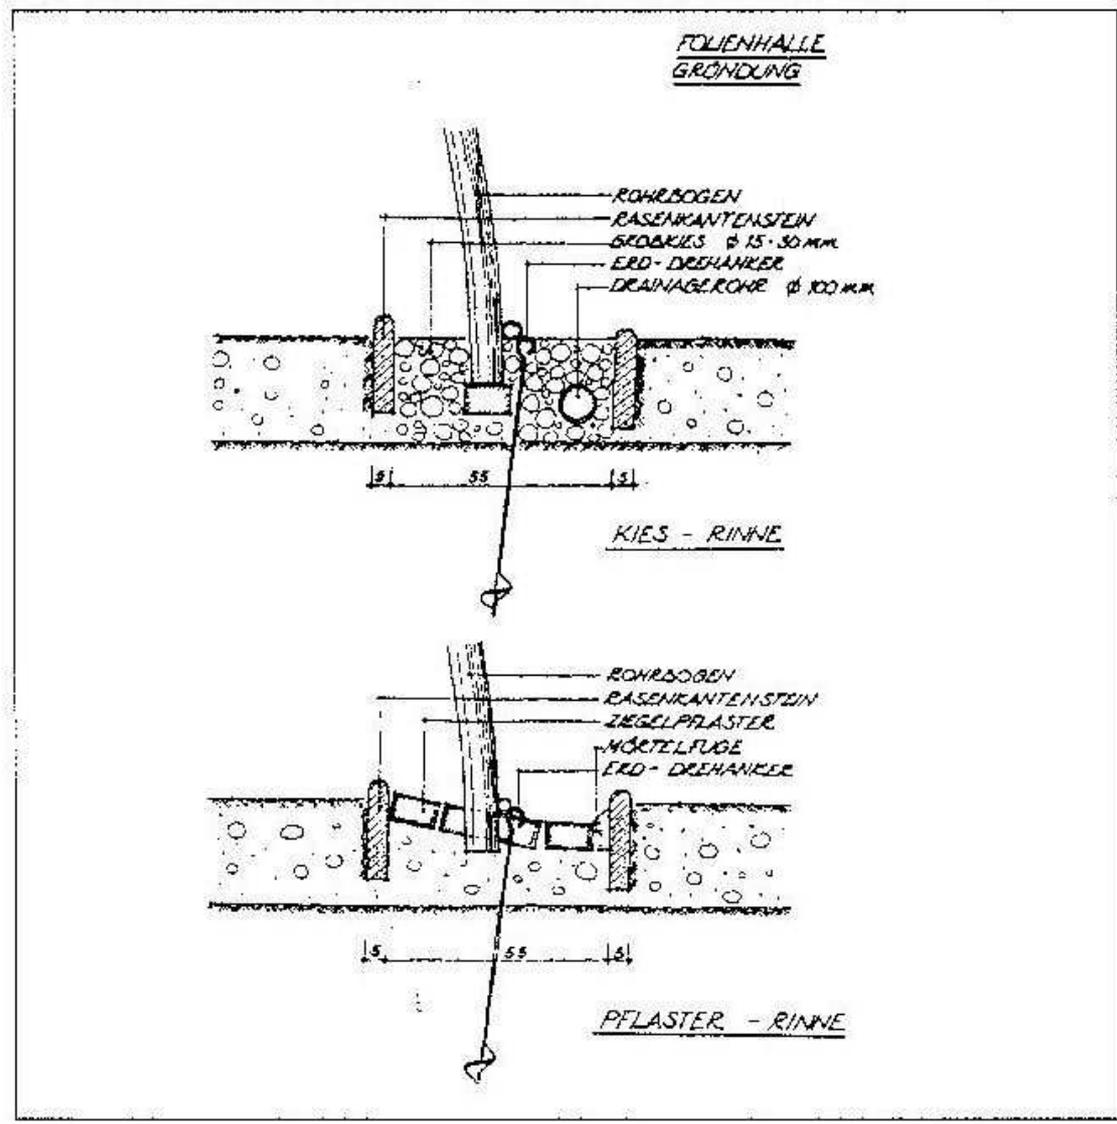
Gründung einer Folienhalle mit Ausbildung des Fußpunktes
